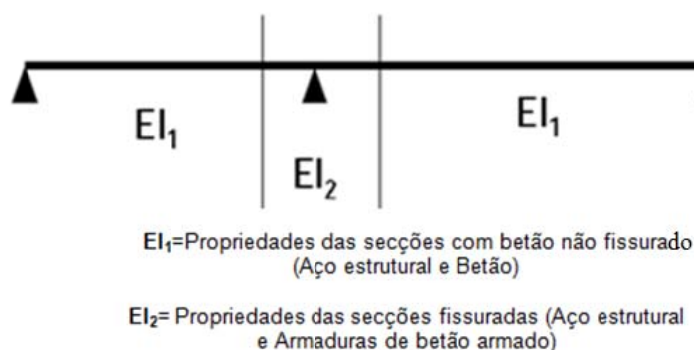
Redução de Inercia devido à fissuração do betão
